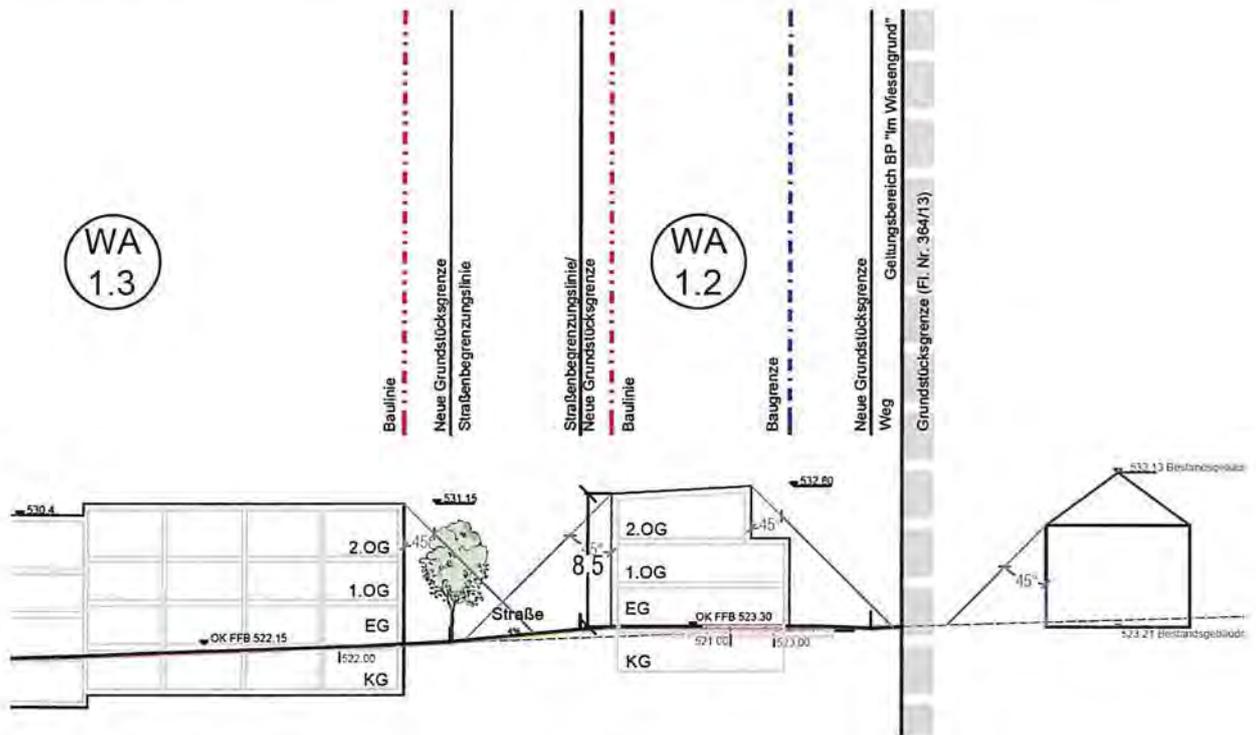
Ausschnitt aus Schnitt A-A, o.M.
